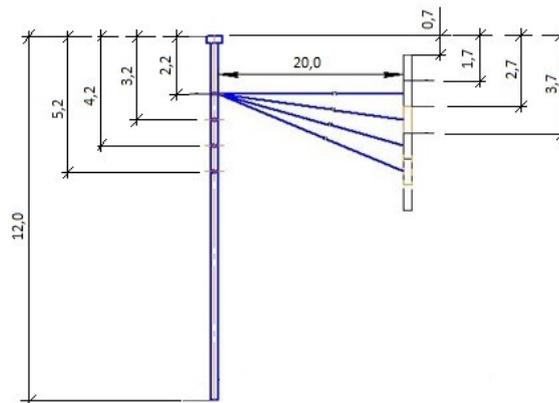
Схема к расчету конструкции двуханкерного больверка:
